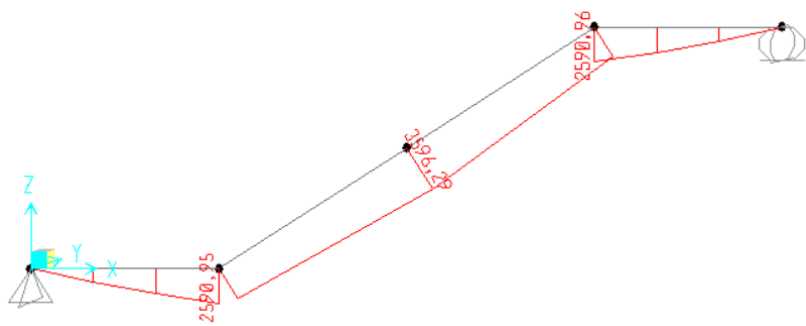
Sketsa Pembebanan Balok Utama Tangga
